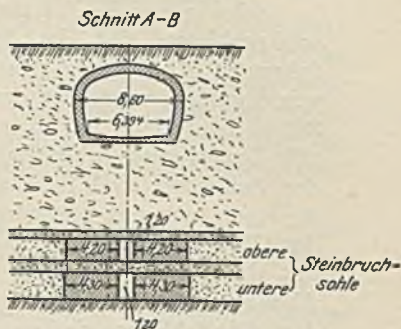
a. Querschnitt durch Ausmauerung und Stollen.
